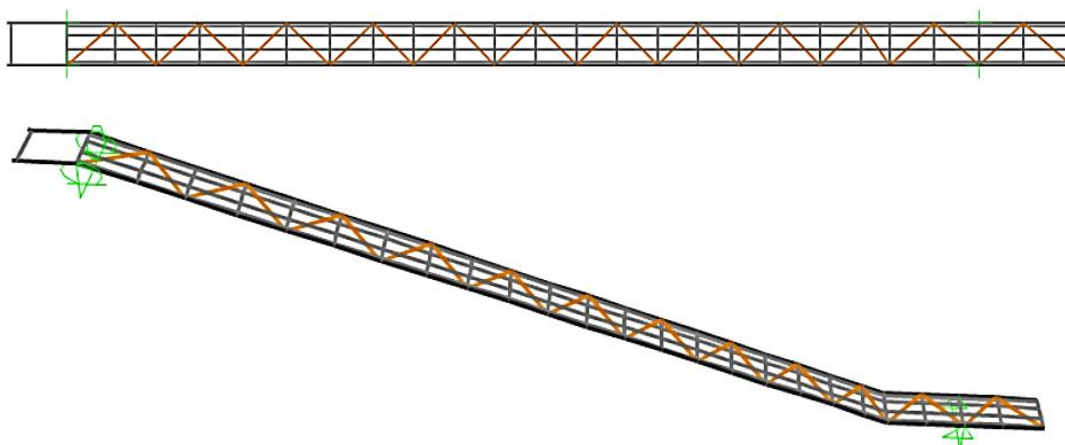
Painel Horizontal inferior - Vista em Planta e Alçado
